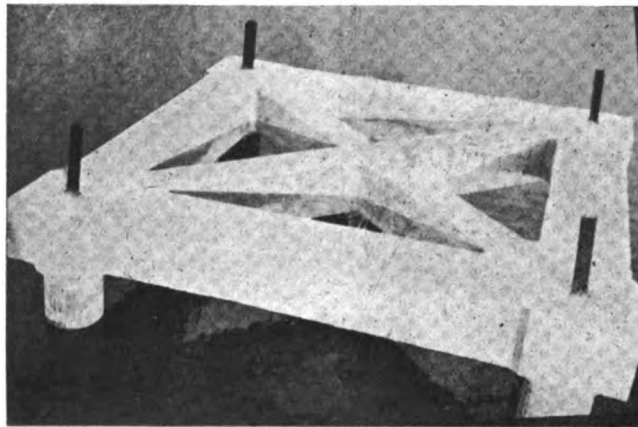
Cavalletto di fondazione (prima del montaggio del palo).
